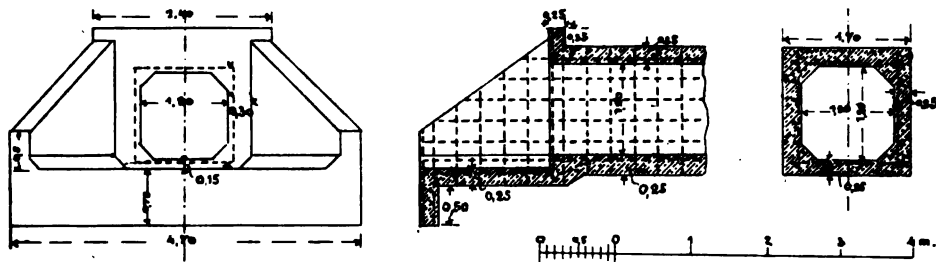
Entwurf einer Deichschleuse (Deichsiel) mit einfügligem Tor.
